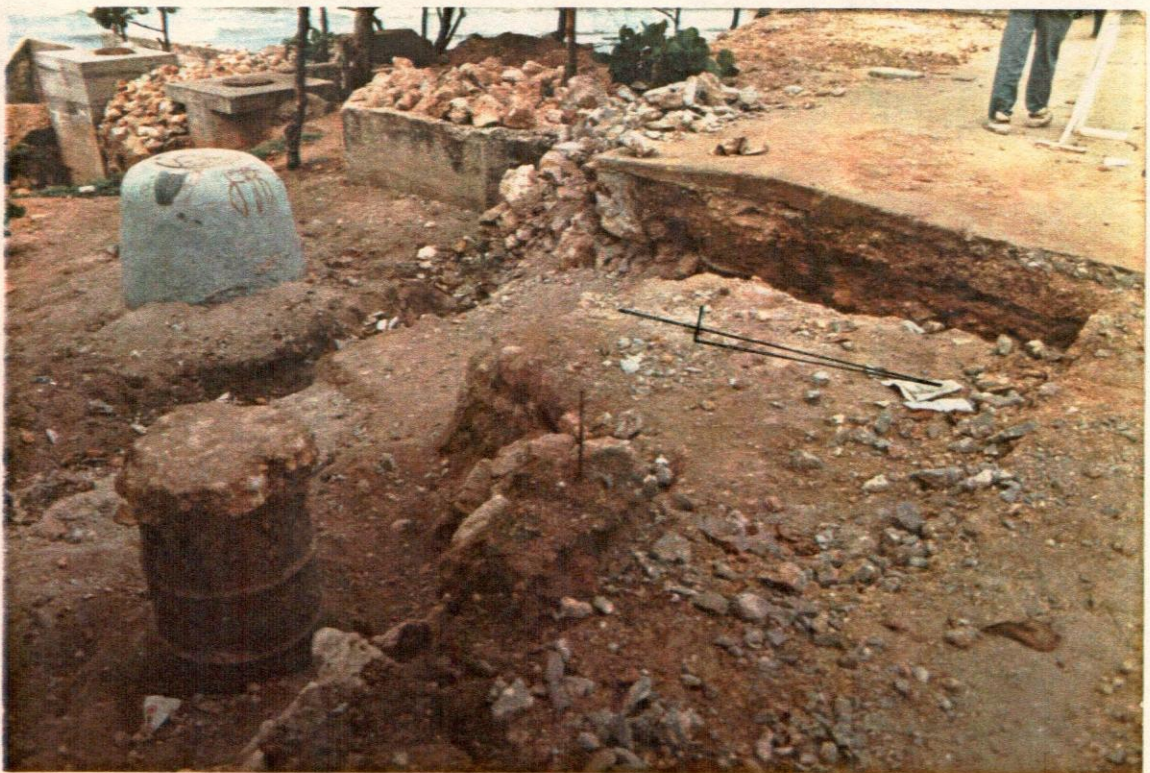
Detalle de registros sanitarios , orientados de Sur a Norte.
